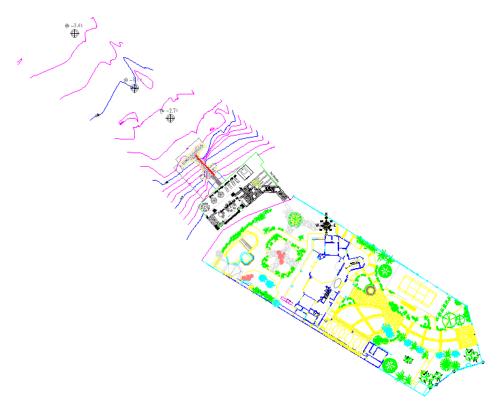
Vista de planta del proyecto donde se puede observar la casa del promovente, el acantilado la escalinata, plataforma fija de amenidades y muelle, Bahía de Bacochibampo, Golfo de Baja California, Guaymas, Sonora México.
